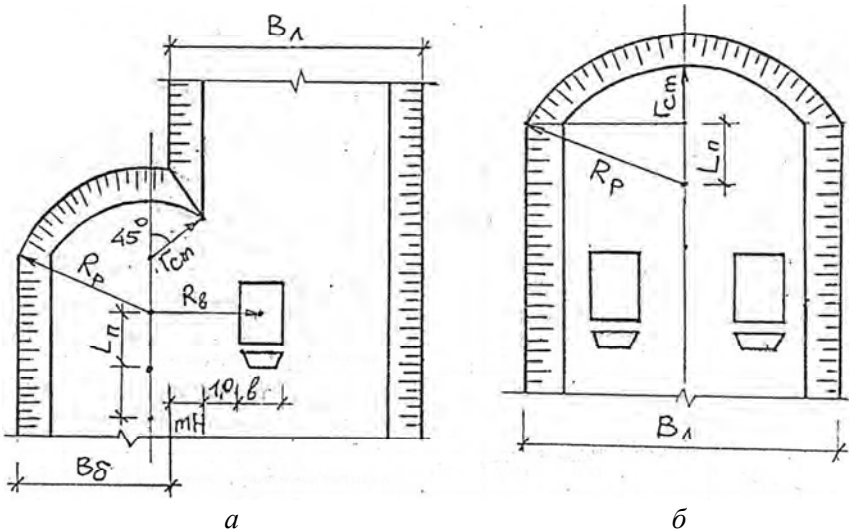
Схемы разработки котлована экскаватором прямой лопатой боковой (а) и лобовой (б) проходками
